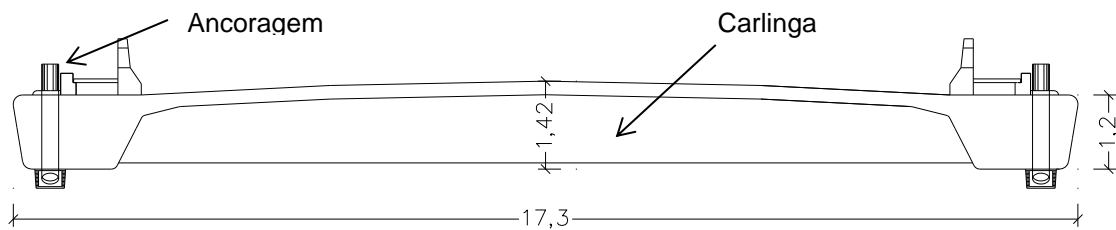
Secção transversal típica da zona atirantada da ponte (adaptado [11])
